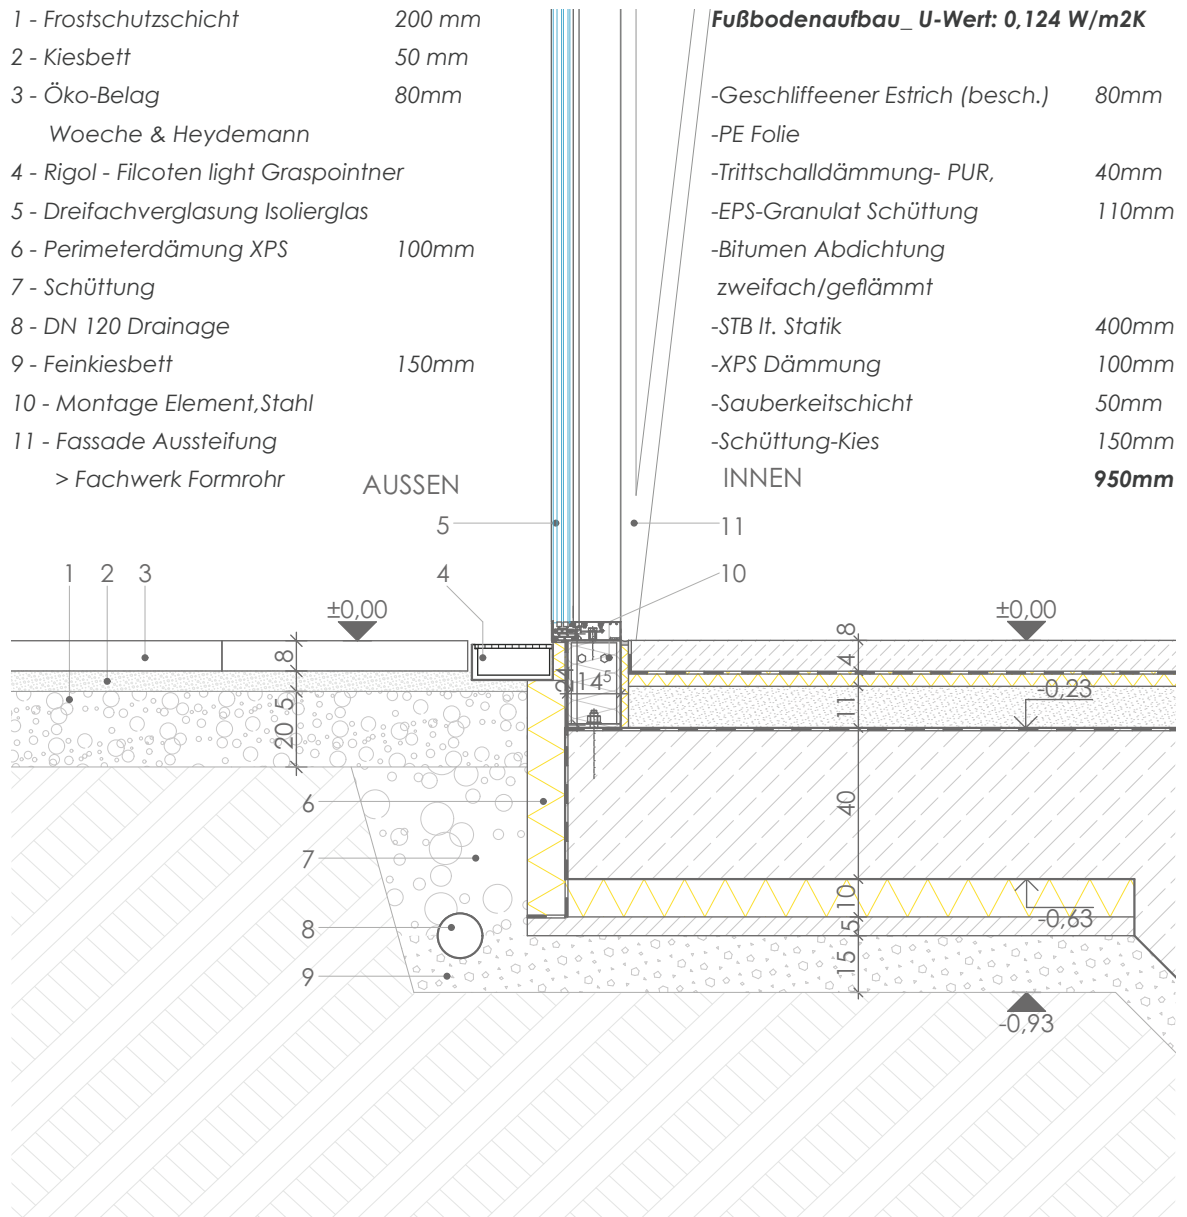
Detail 01 - Sockel > Fassadenanschluß / M 1:20
